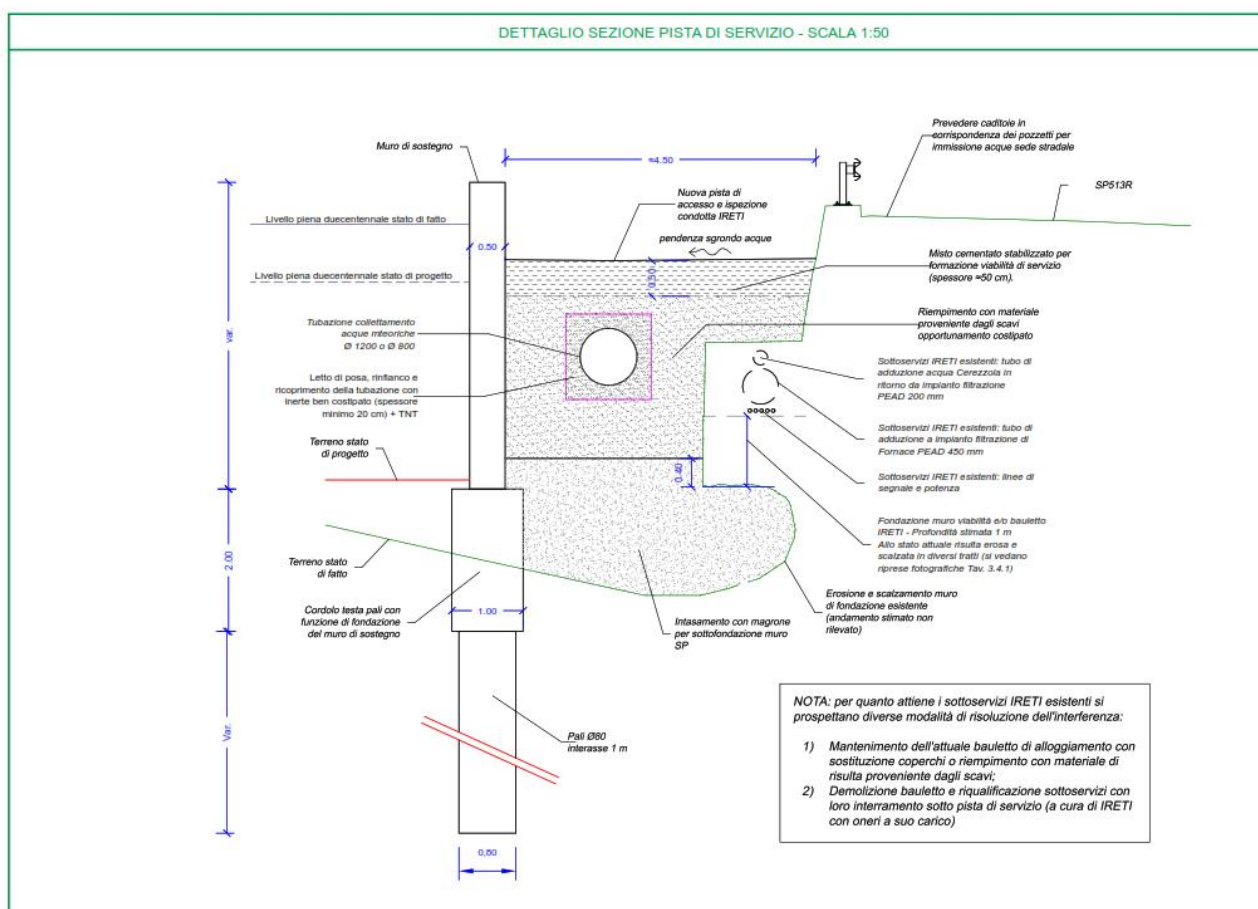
Sezione della pista di servizio e protezione dell'adiacente SP
